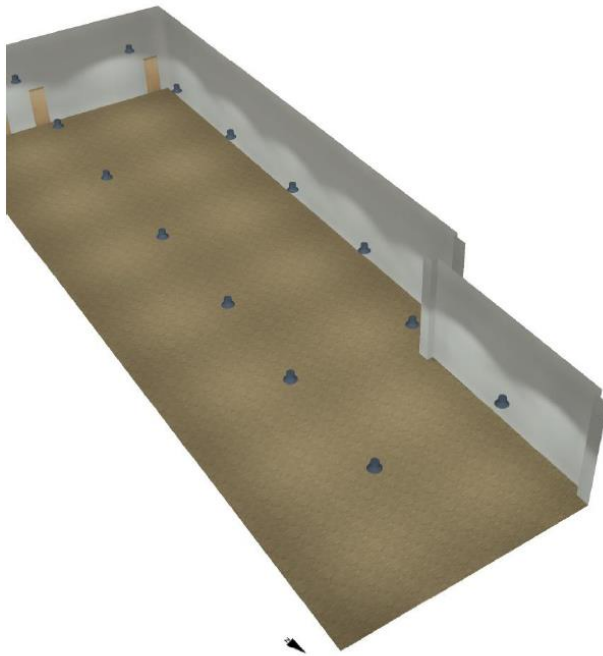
22. Render 3D Local 1 Planta Baixa (Font: Dialux 4.13)
